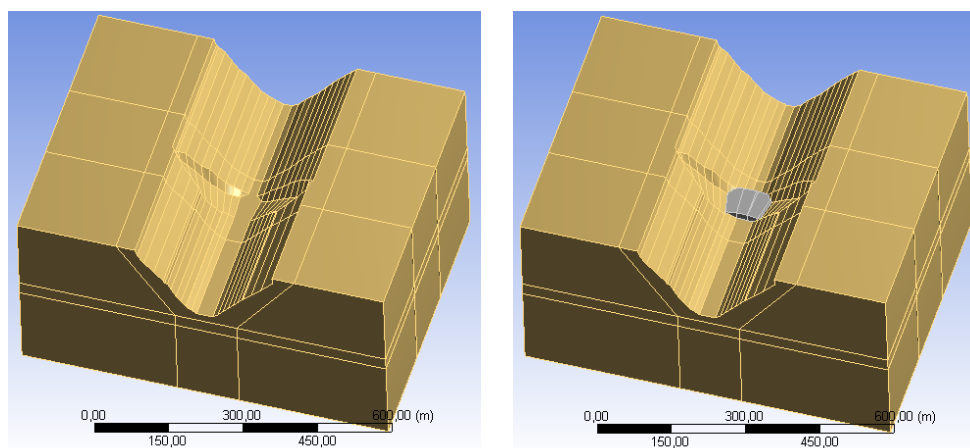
Proceso constructivo. Terreno con excavación y primera capa.
